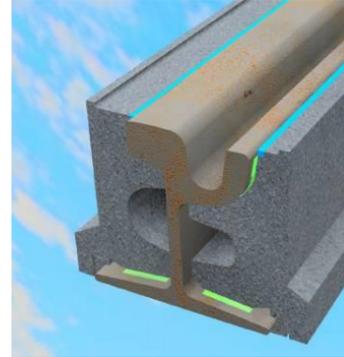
Detalle de sección vía embebida con carril pre-revestido
